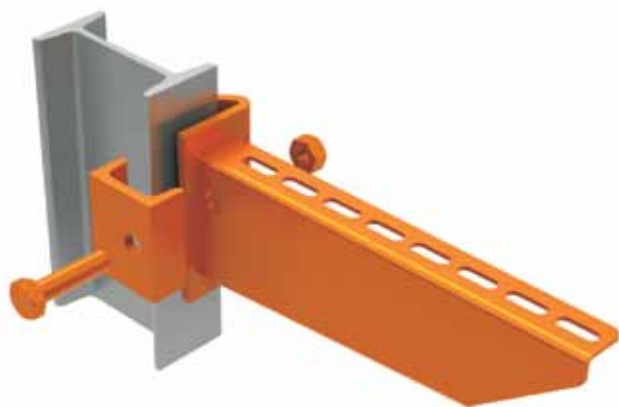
Держатель быстрого зажима для больших нагрузок DRT
